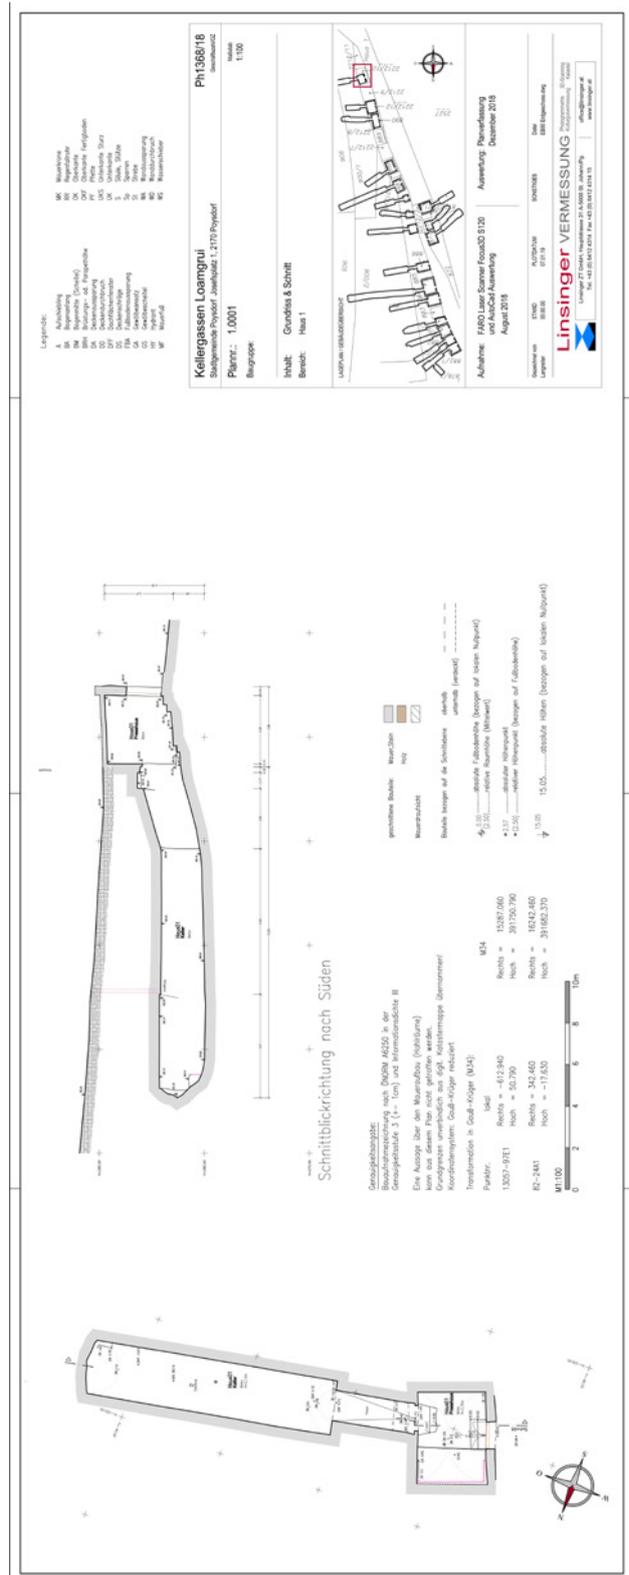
Grundriss und Schnitt durch einen Keller mit Presshaus
